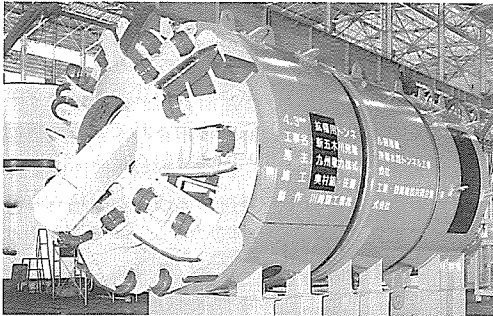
既設トンネル拡幅用TBM(φ4.3m)
